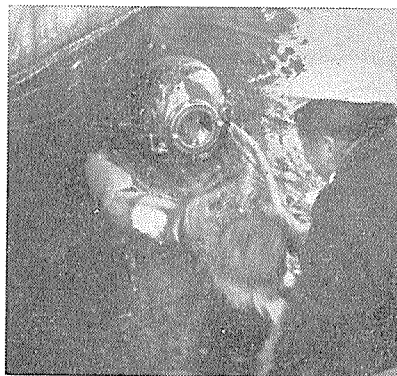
(a) 鉄筋引抜き試験状況 (正面)
